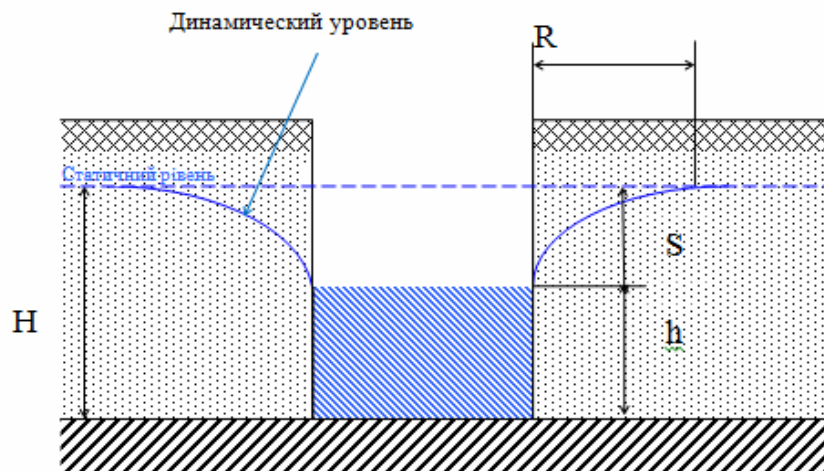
Схема притока грунтовых вод к совершенной траншее
